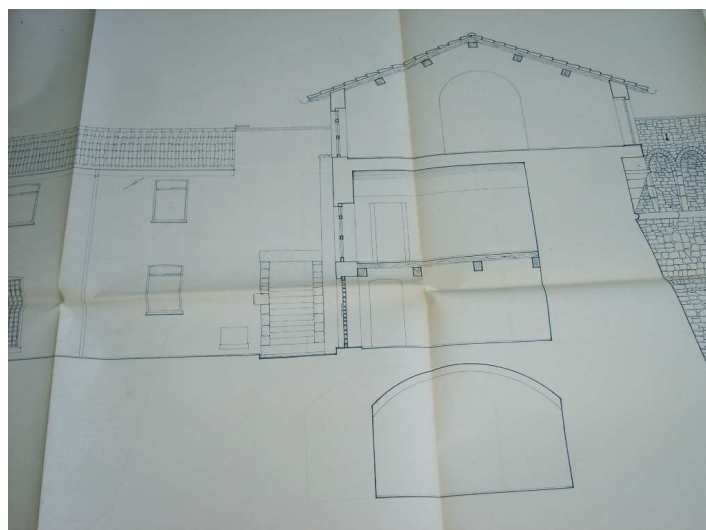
progetto SBAPL-1° cortile-corpo est prospetto (stralcio) e sezione corpo est
